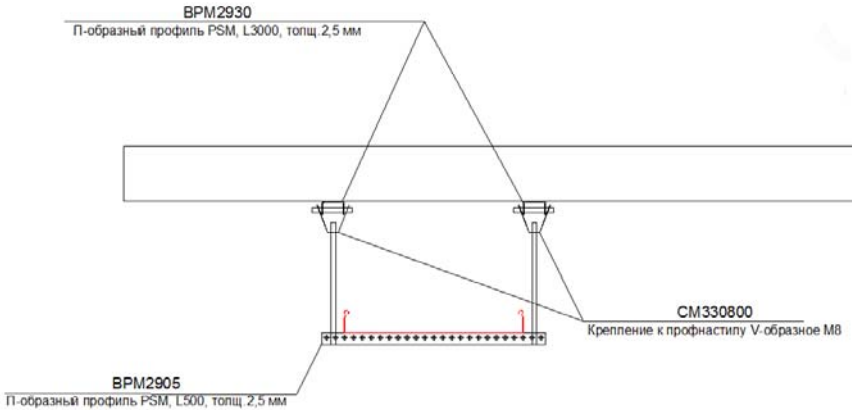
Общий вид подвеса с помощью V-образного крепления
